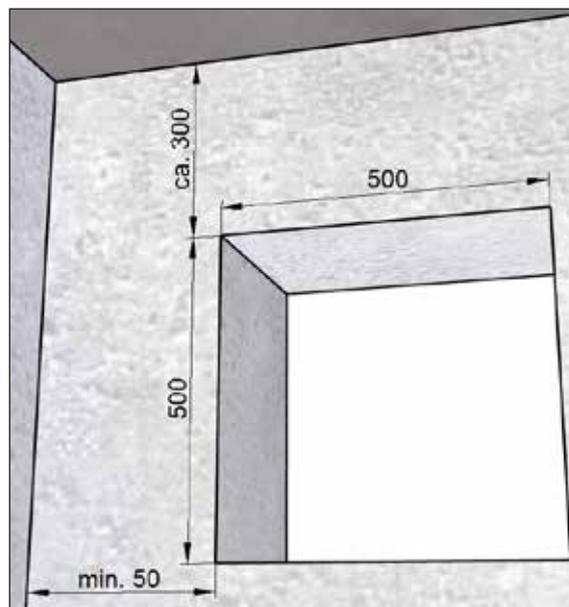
Ouverture dans le mur pour le kit de montage avec pièce de remplissage, dimensions en millimètres
